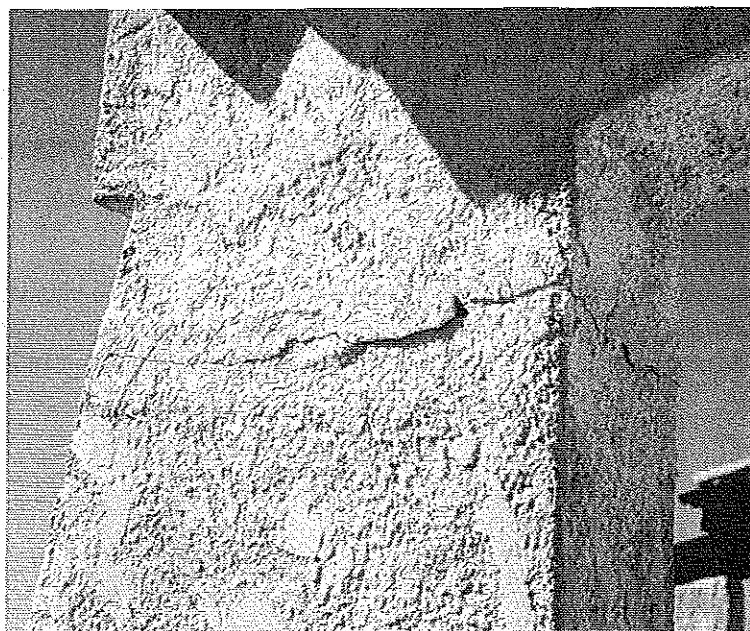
Détail fissure ; décollement de l'enduit. © J. Putatti
